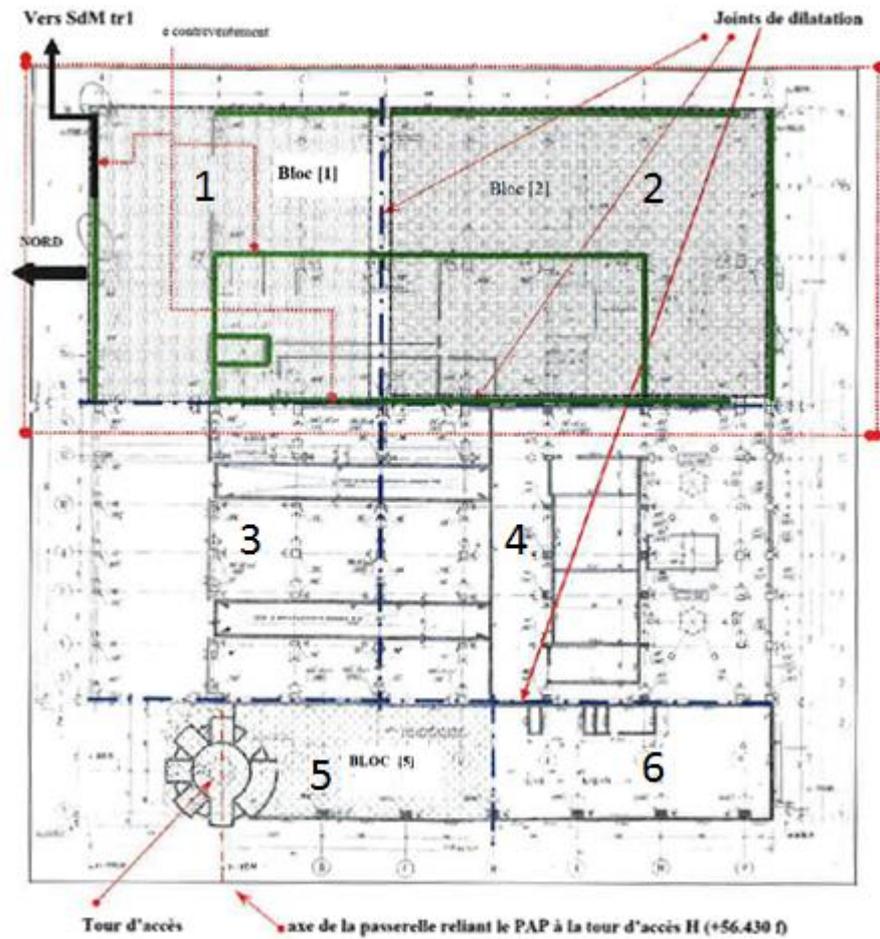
Vue en plan du Bâtiment H du CNPE de Paluel
